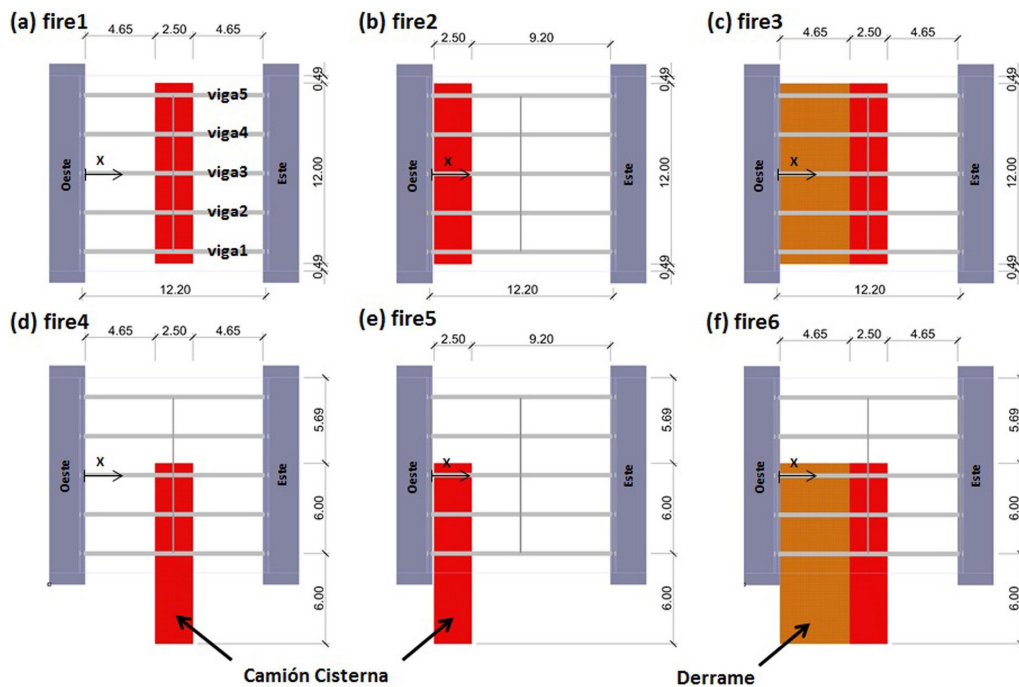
Posiciones de las cargas de fuego: (a) *fire1*: centro luz - viga central, (b) *fire2*: próxima estribo - viga central, (c) *fire3*: centro luz con derrame - viga central, (d) *fire4*: centro luz - viga extrema, (e) *fire5*: Próxima estribo- viga extrema, (f) *fire6*: centro luz con derrame - viga extrema.
